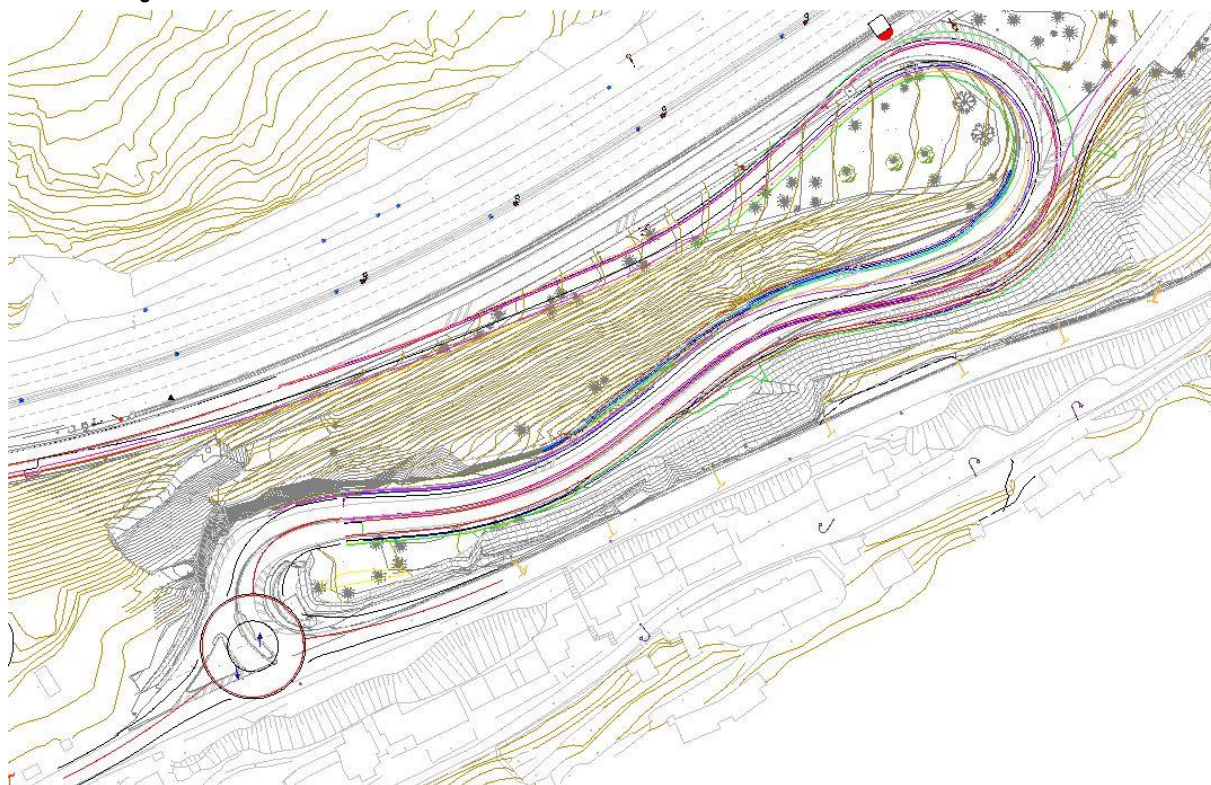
Plan d'aménagement (Source : ESCOTA)
